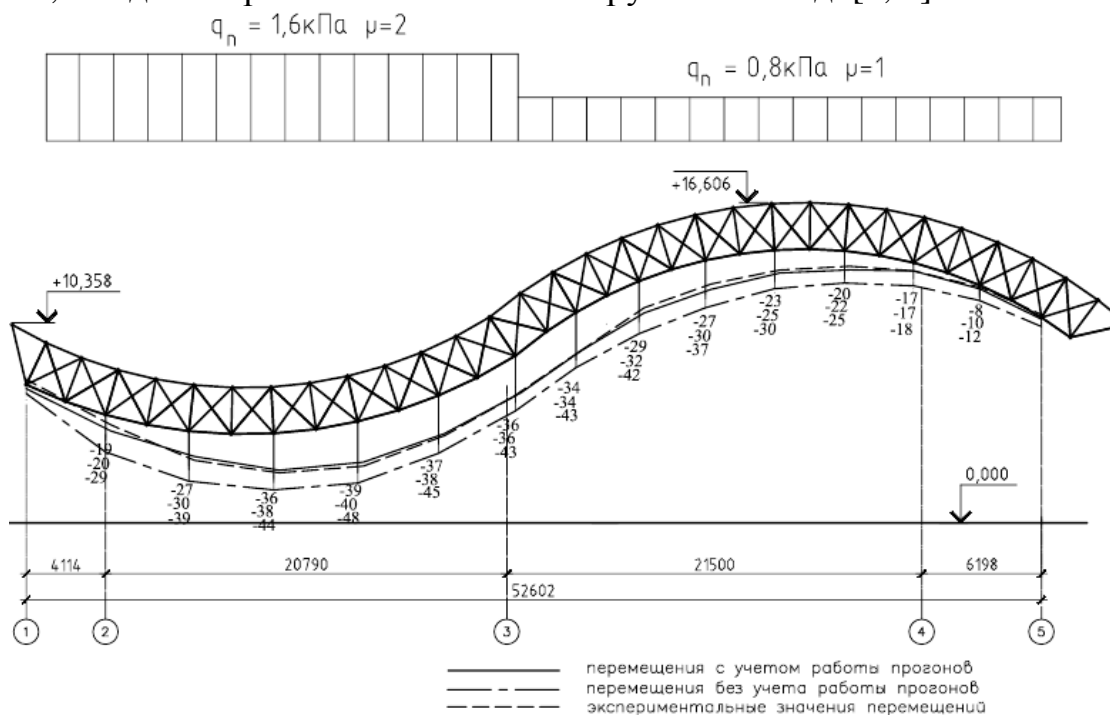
Схема нагружения покрытия снеговой нагрузкой и эпюры вертикальных перемещений узлов нижней поясной сетки по оси В
